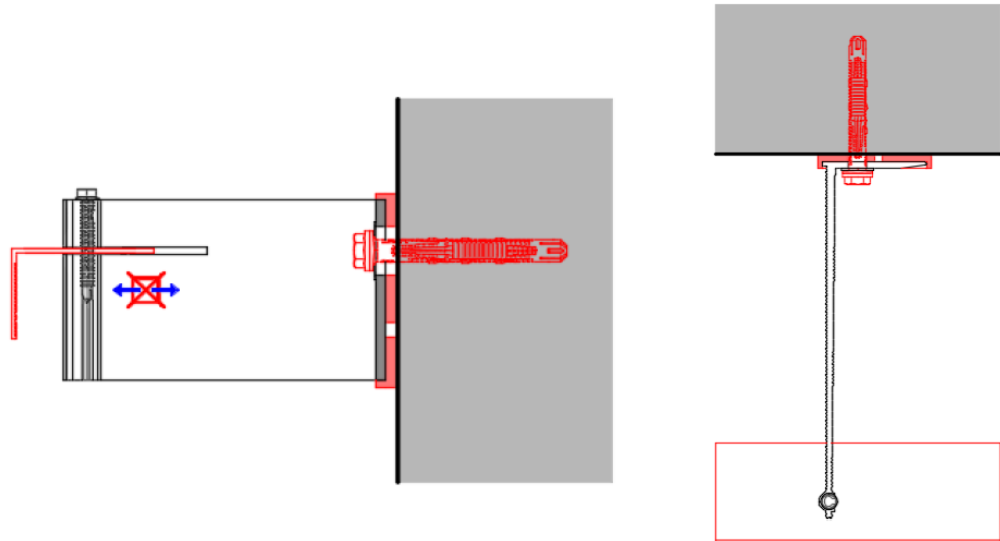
Wittmayergasse 2 – Detail der Unterkonstruktion [HIL16]
